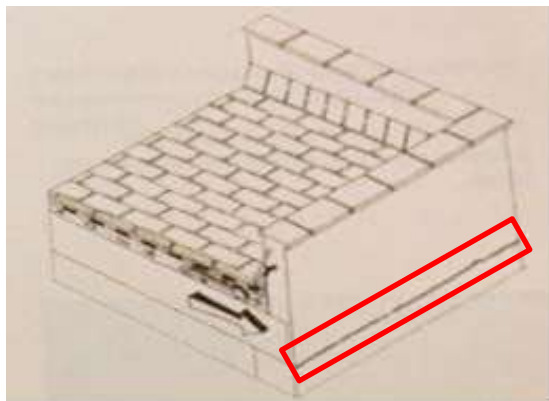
Fissuras devido ao movimento da laje, sem isolamento (Trujillo e Caula, 2003)
